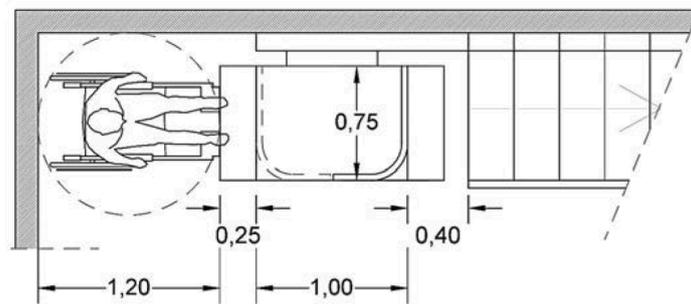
3. Previsión de espacio en las zonas comunes para instalar una plataforma elevadora inclinada
